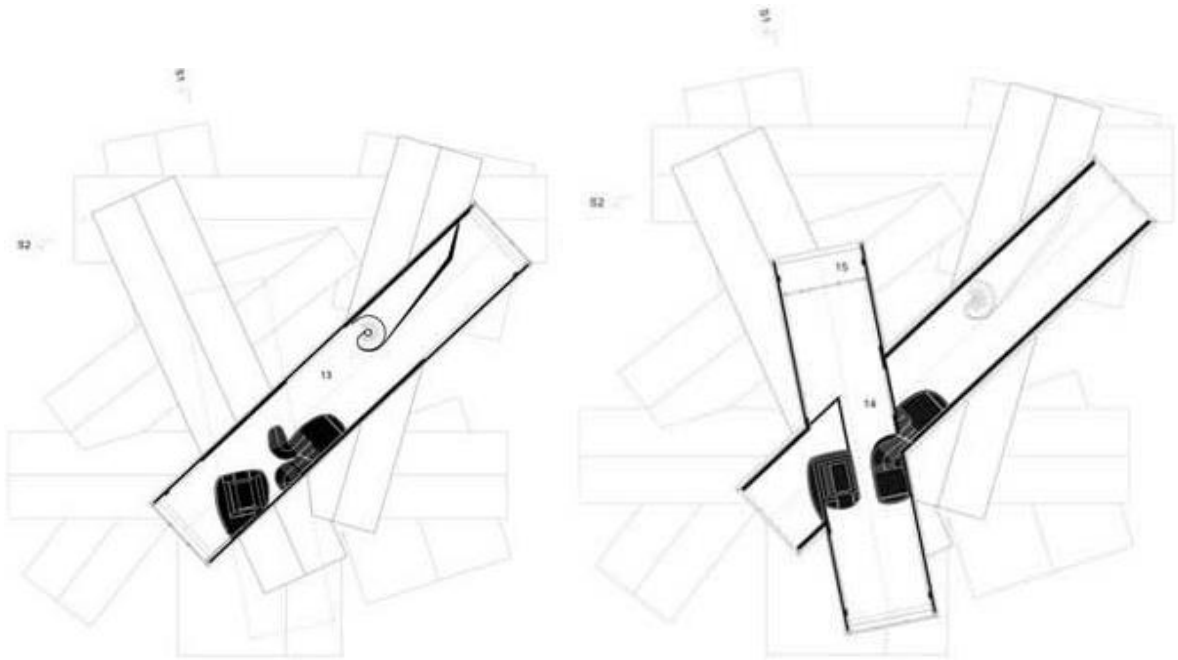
Plantas esquemáticas - VitraHaus. Fonte: Arcspace, 2010
